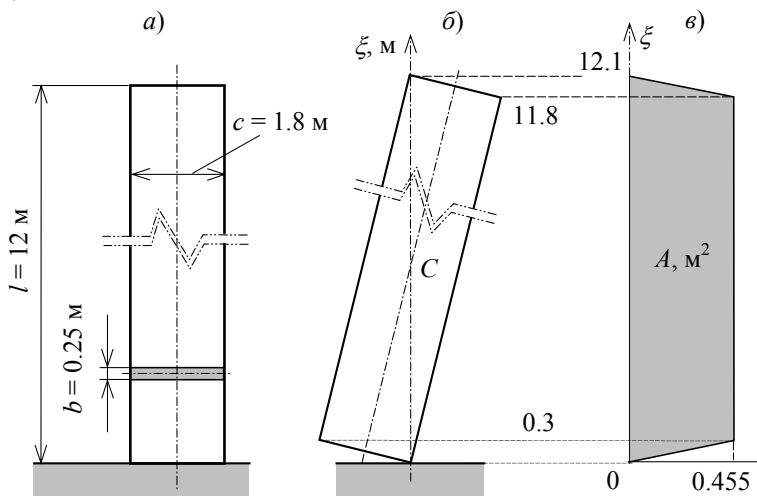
Схема падения железобетонной панели: а – удар торцом; б – удар углом; в – закон изменения расчетной площади при ударе углом
